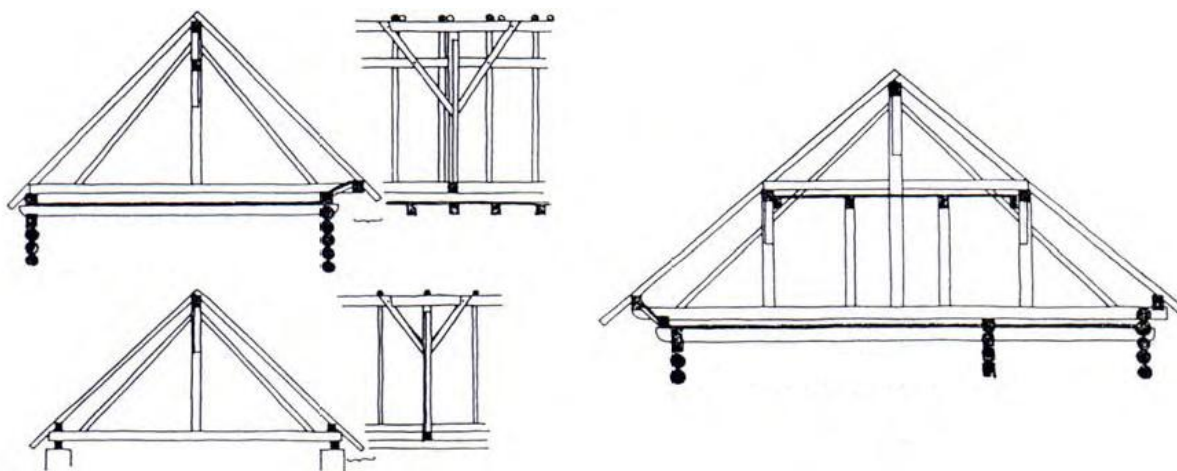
Exemplos de estruturas das coberturas construídas no século XV. Kuklík (2008a).
